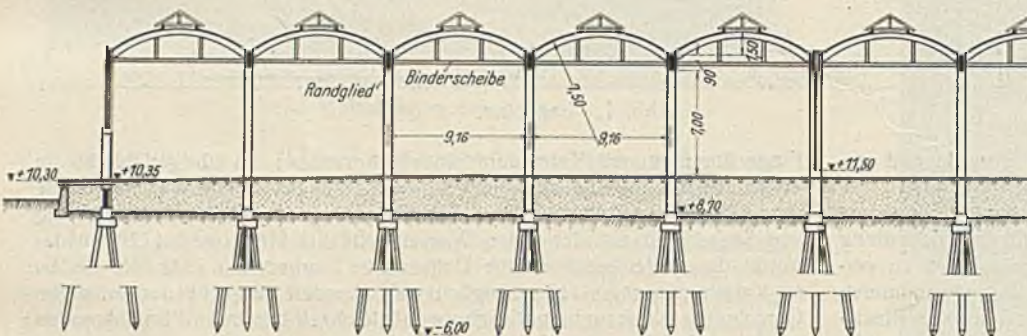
Längsschnitt durch den Kaischuppen in Eisenbeton-Schalbauweise.
